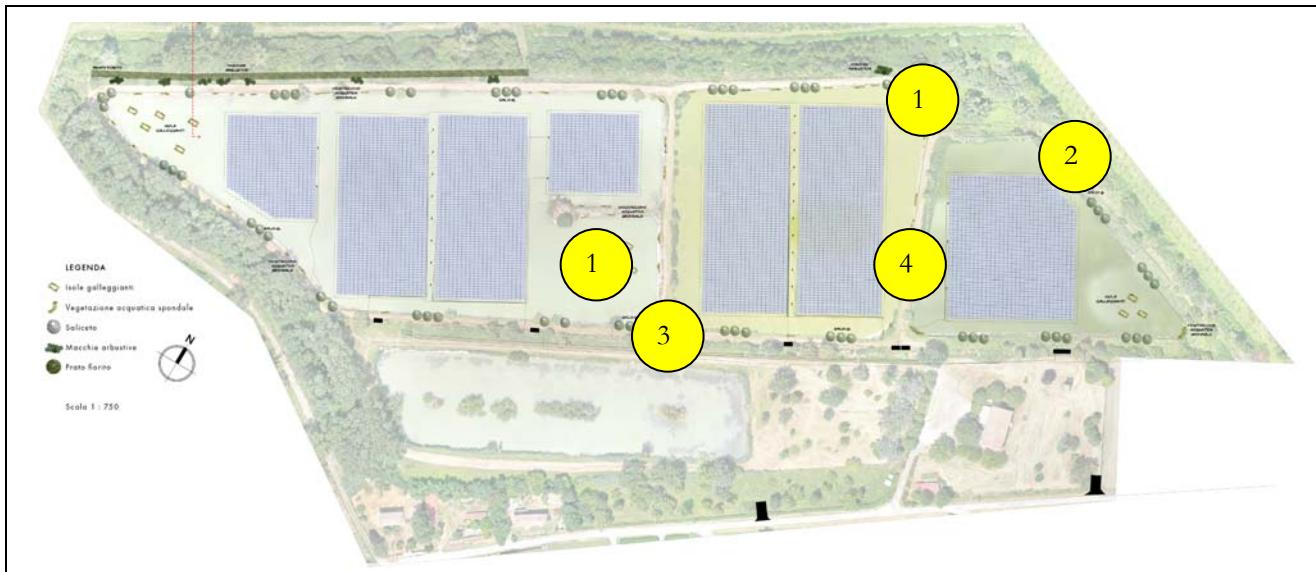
Planimetria degli interventi di valorizzazione ambientale
